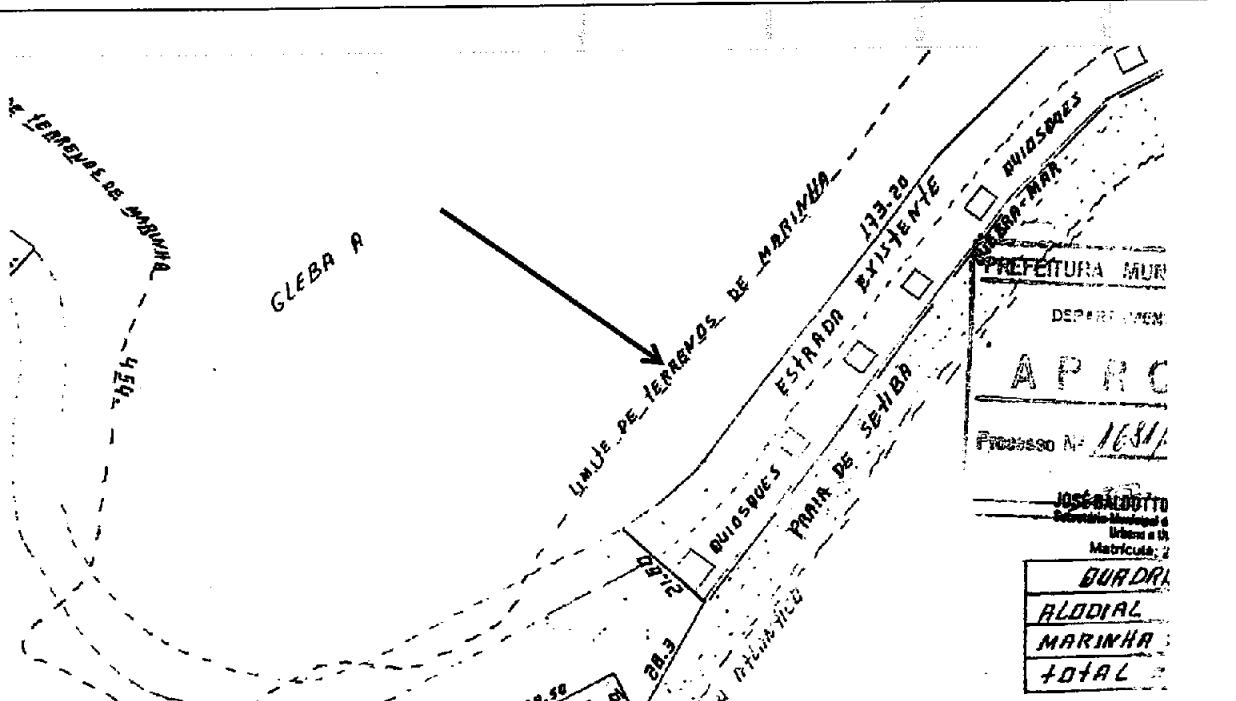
Foto F: Marcação do Terreno de Marinha em Planta Aprovada na Prefeitura (fonte: Solicitante)
